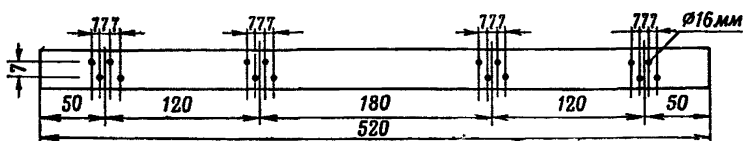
Шаблон для разметки отверстий в насадке и лежней опор
